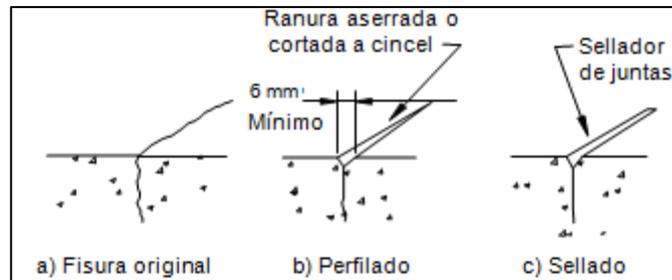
Reparación de una fisura mediante perfilado y sellado (Johnson, 1965)
